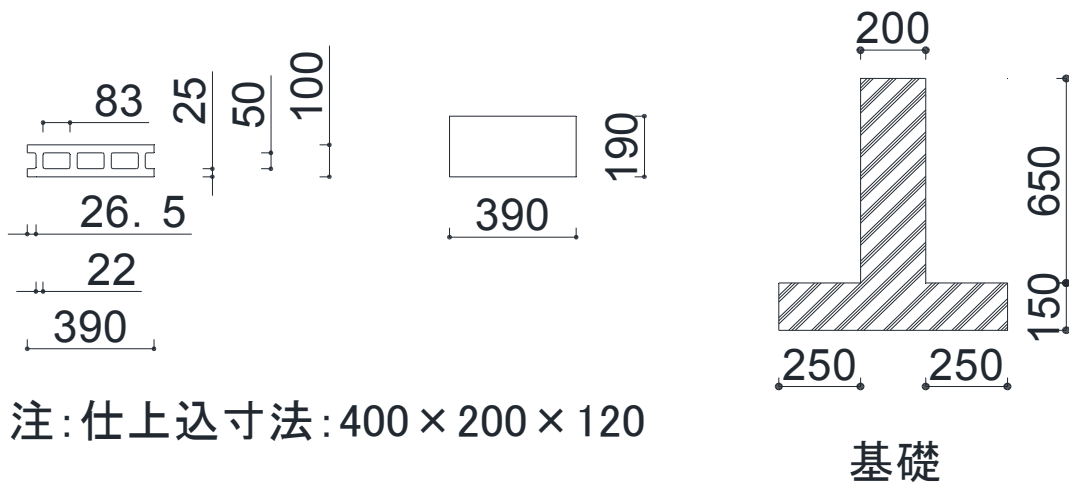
CB および基礎寸法図 (単位: mm)
